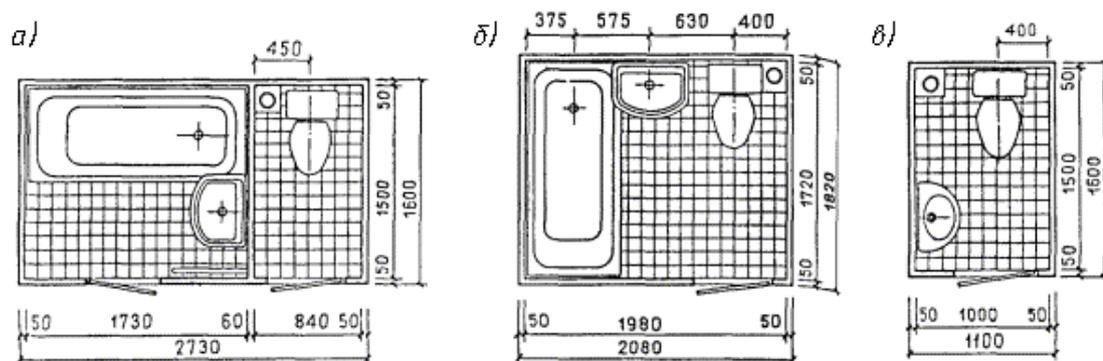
Планировочные решения объемных железобетонных санитарно-технических кабин: *а* – отдельный санузел; *б* – совмещенный санузел; *в* – туалетная комната
